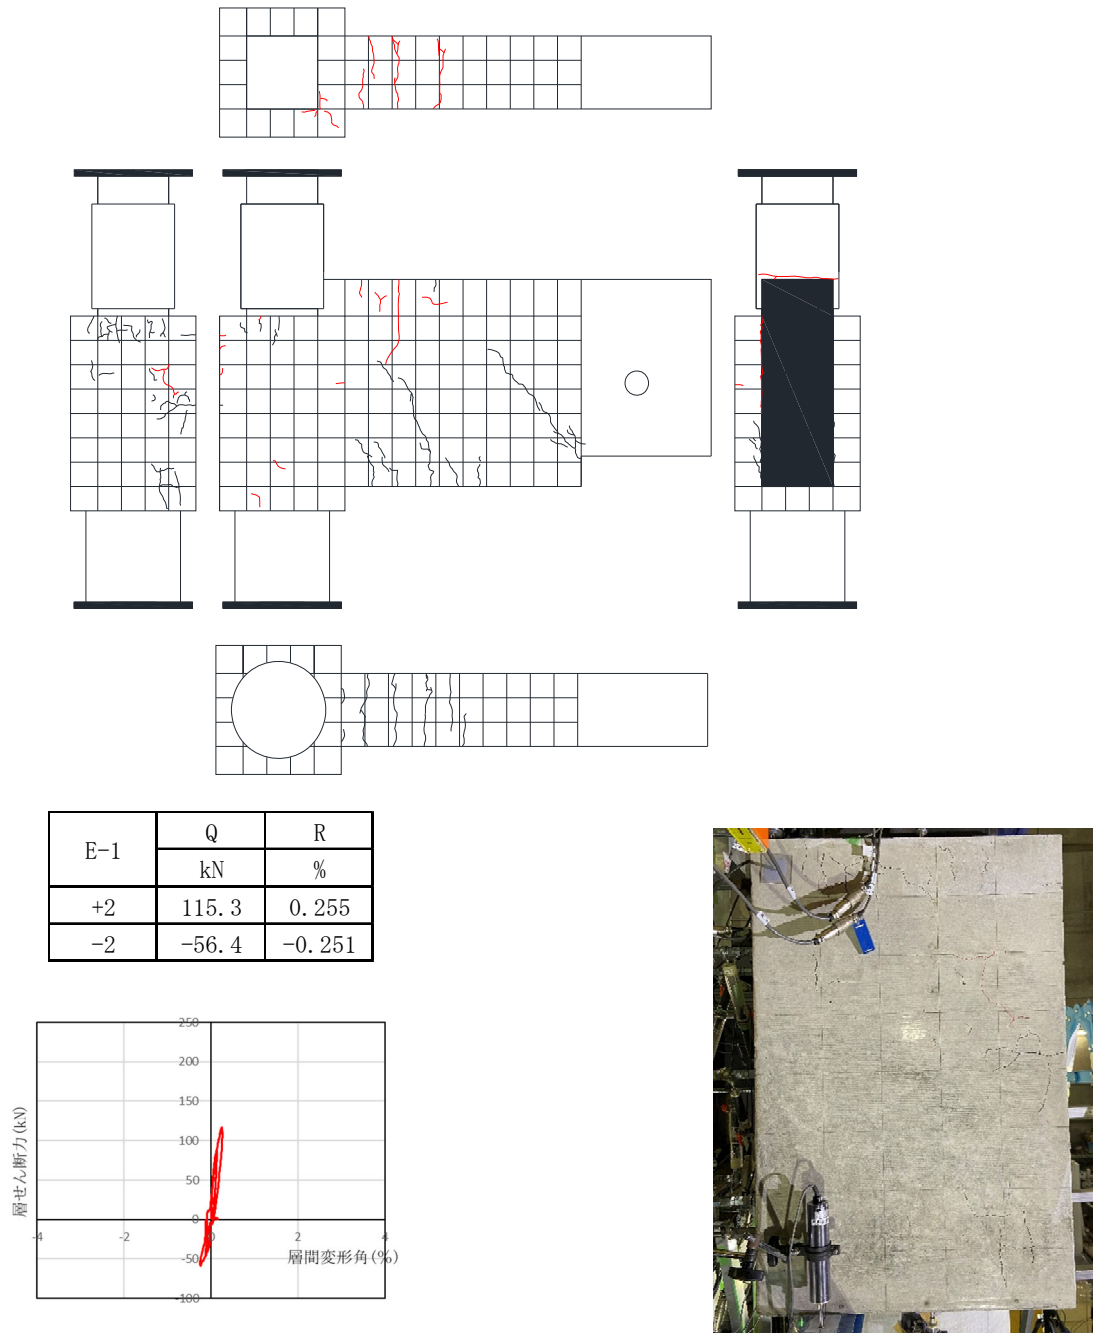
～図・写真 4.3.2-20 に各試験体における各ピーク時のひび割れ状況，部材写真を示す。
